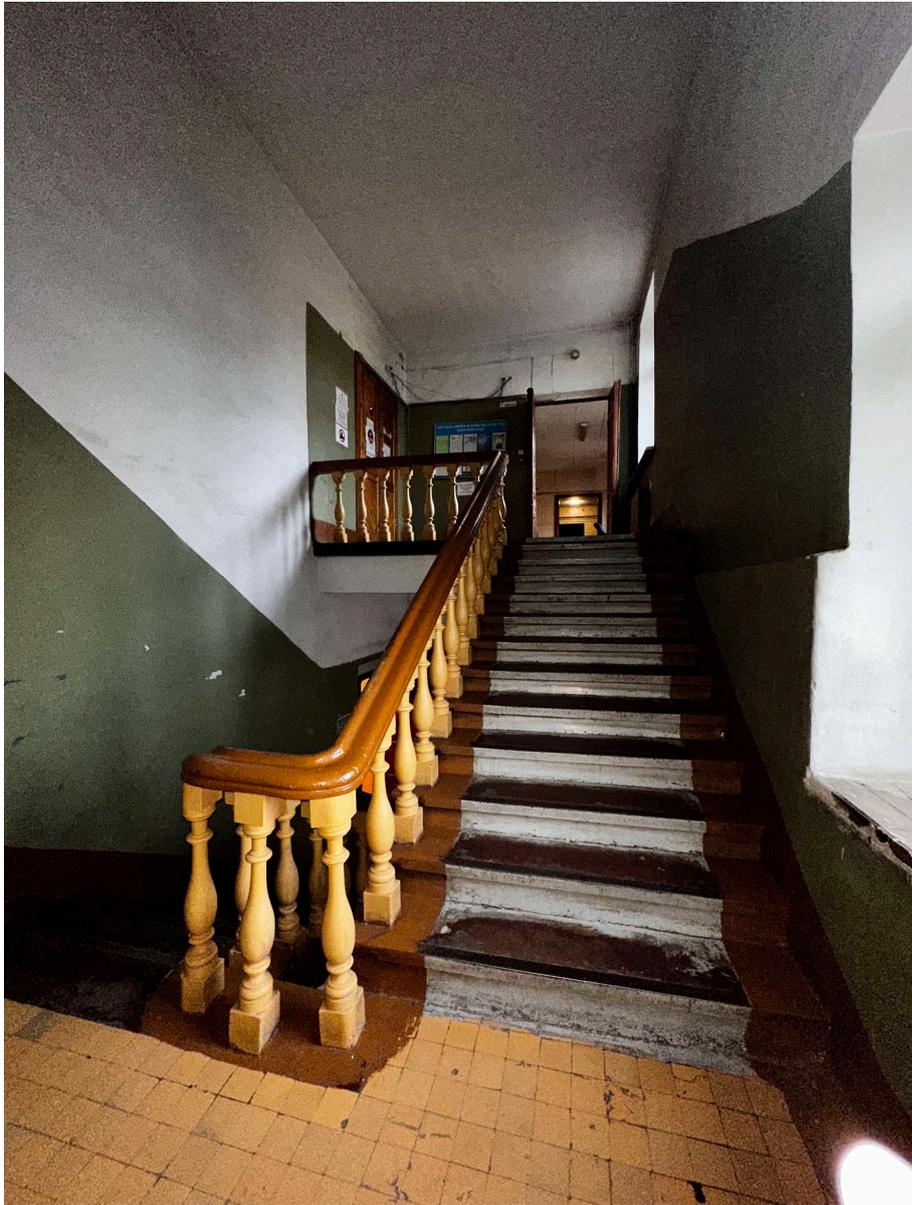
Северное крыло здания. Общий вид лестничной клетки в западной части здания с промежуточной площадки (между 2-ым и 3-им этажами).
